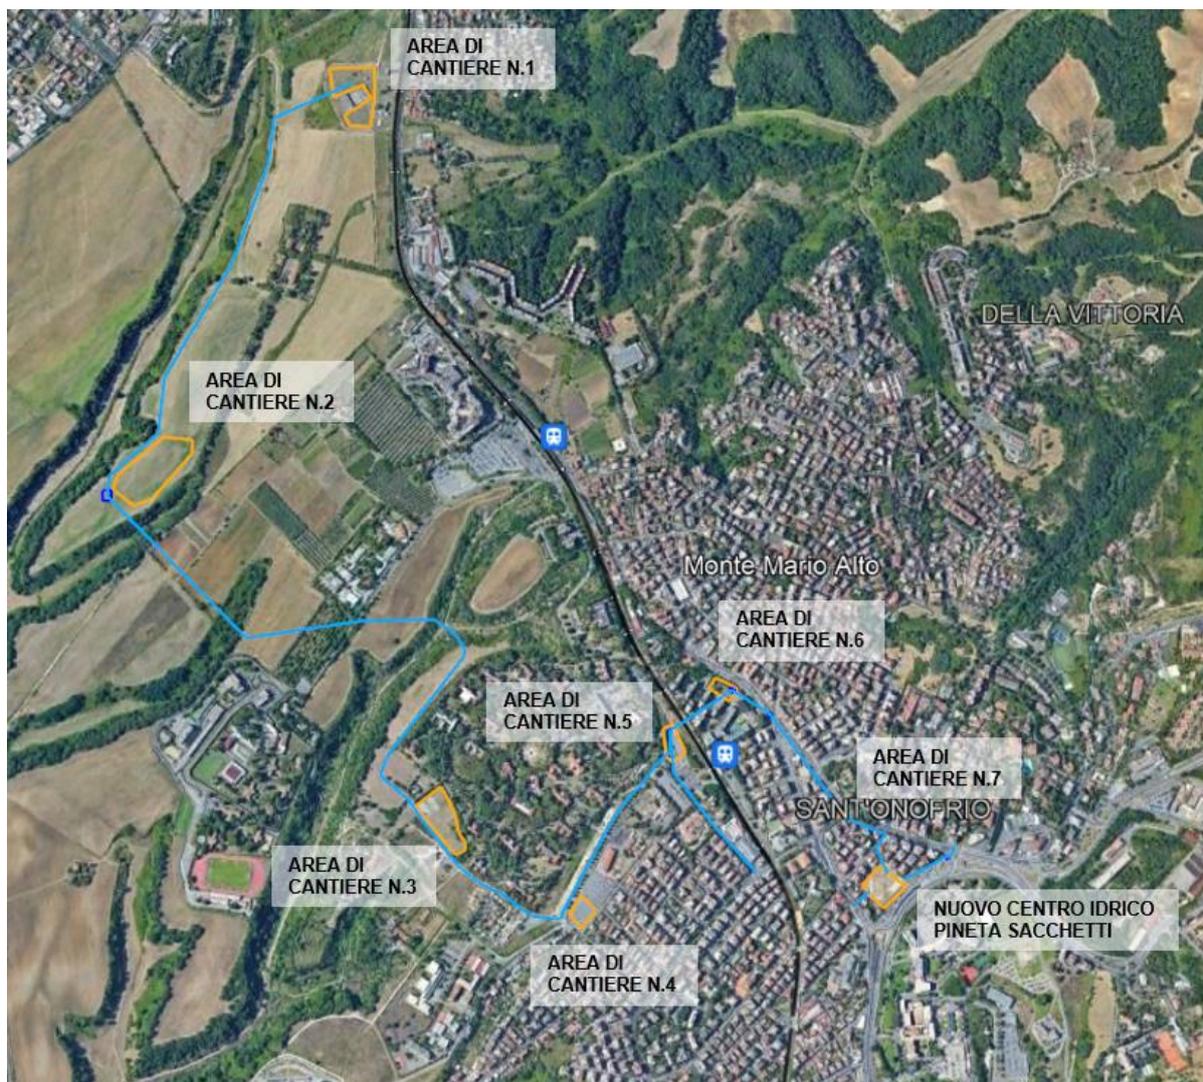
Adduttrice Ottavia - Trionfale. Opere di progetto ed aree di cantiere
